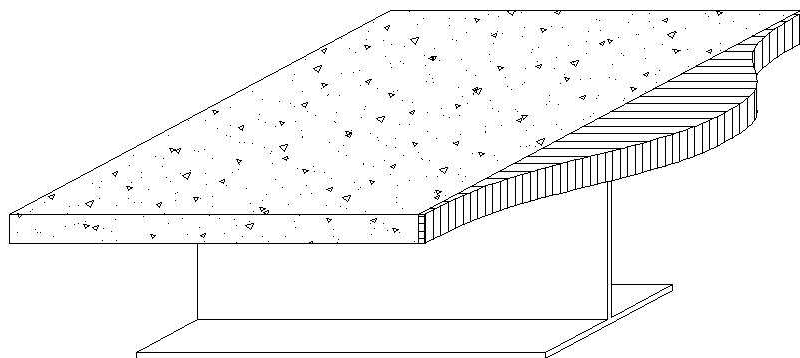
Distribuição das tensões de compressão na laje de concreto.
